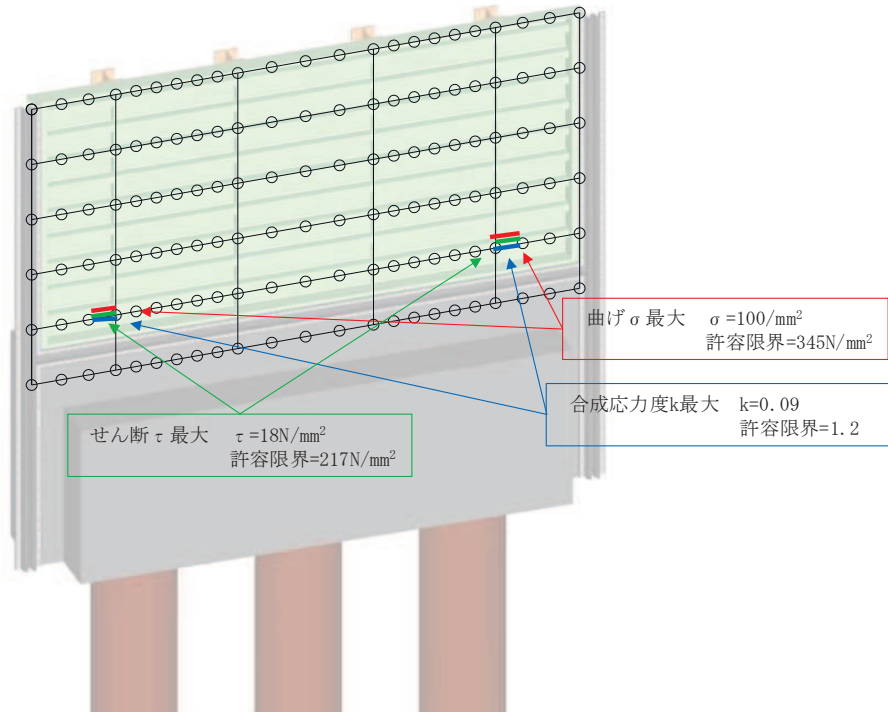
鋼板の曲げ・軸力系の破壊及びせん断破壊に対する
